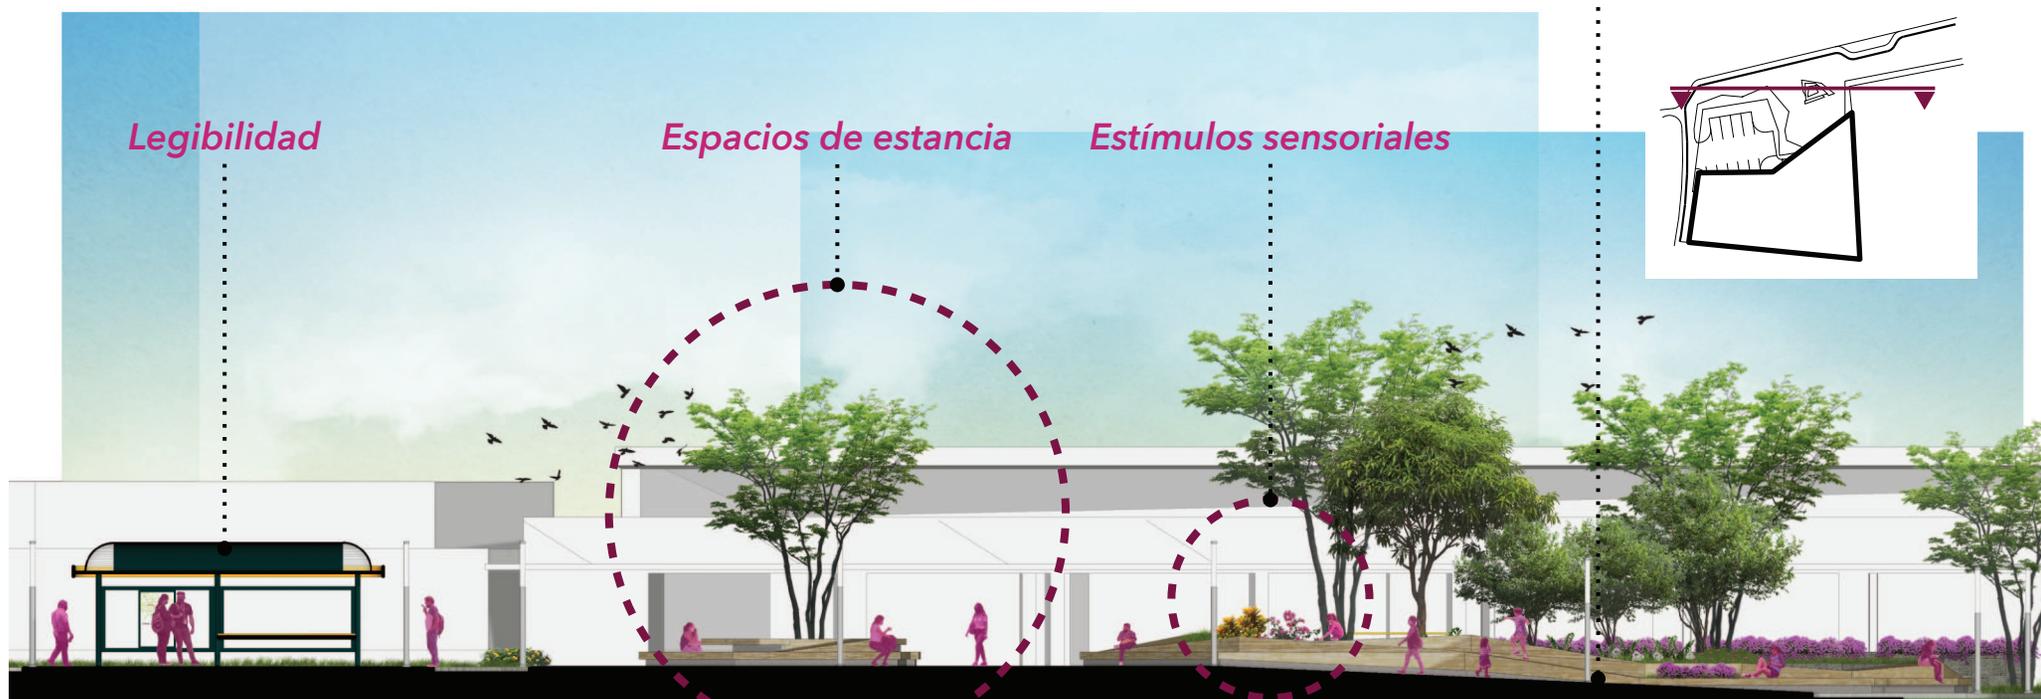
Corte longitudinal de la propuesta. Sin escala.
